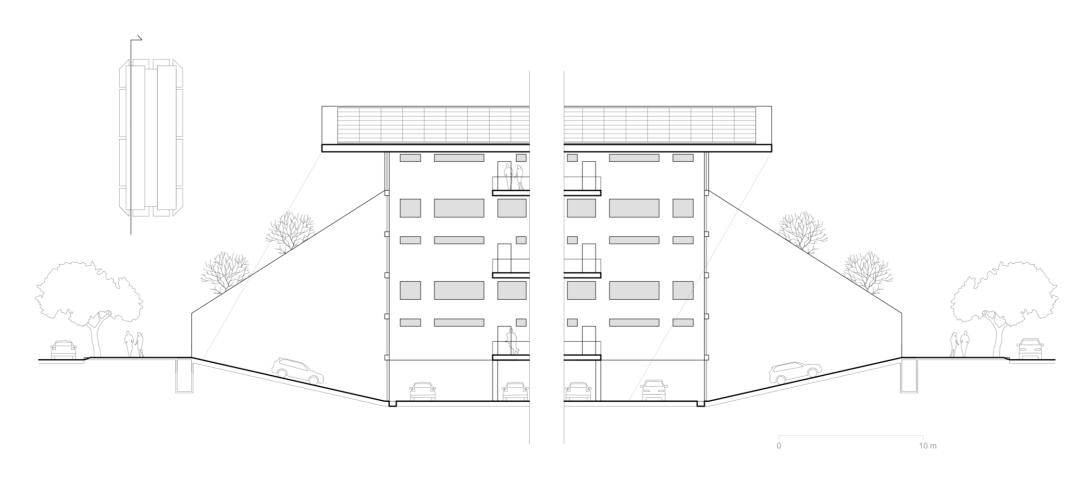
Sección longitudinal del edificio de uso residencial (la sección se ha realizado por uno de los accesos al aparcamiento)
